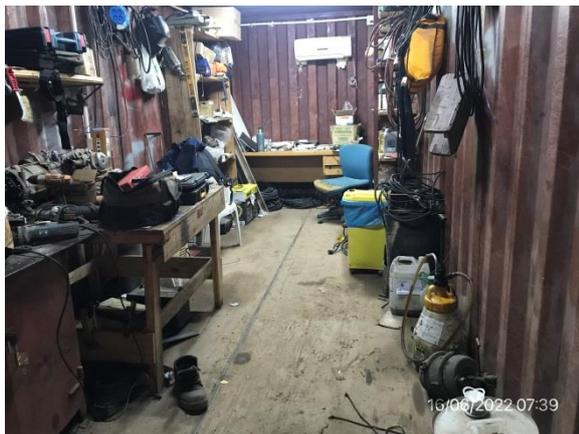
P09, Obrador principal. Pañol en contenedor cerrado con techo y pavimento impermeable
